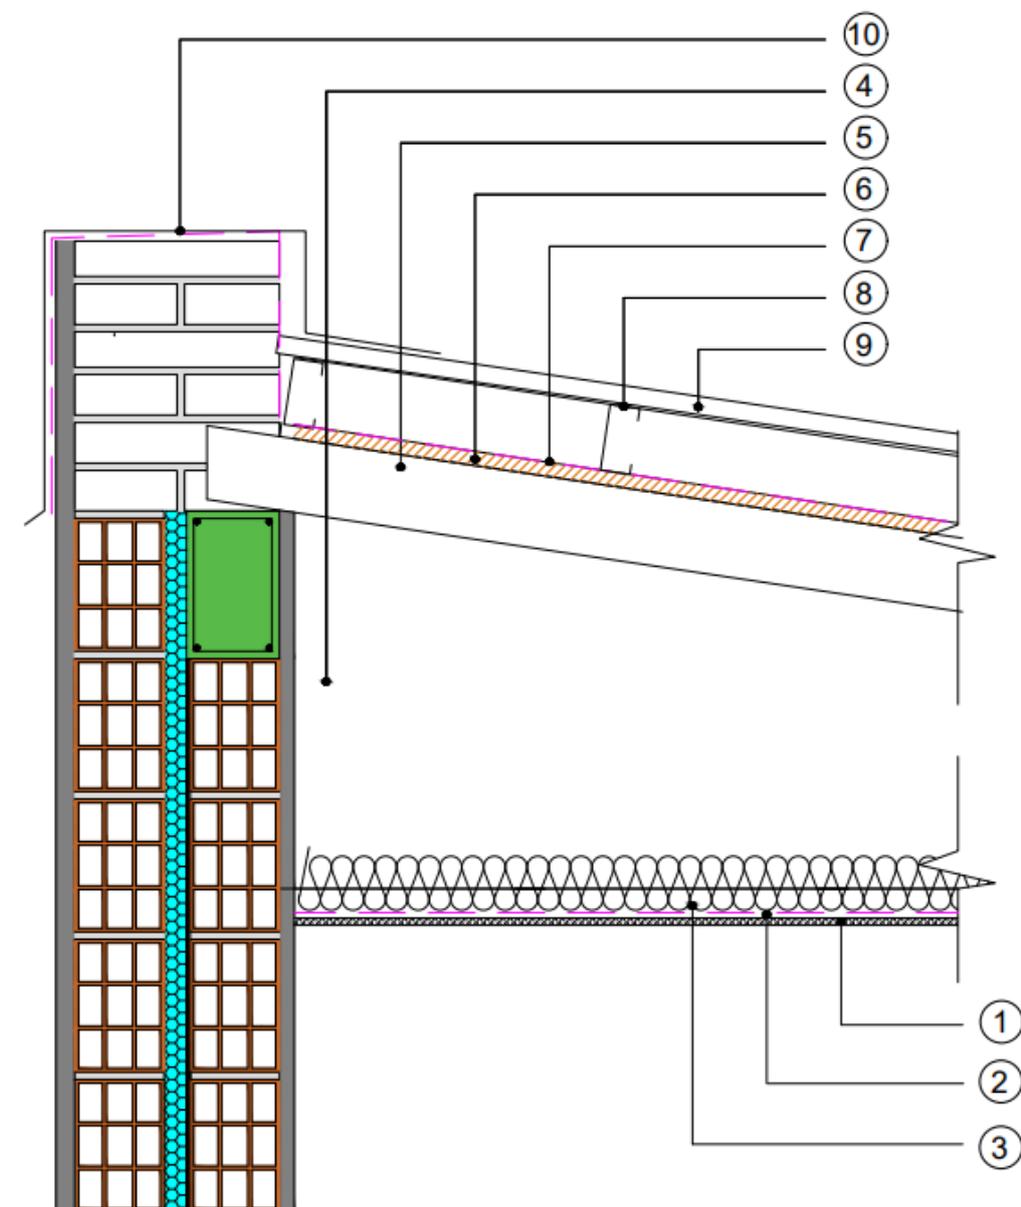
Anteproyecto arquitectónico: detalle del paquete de cubierta.
